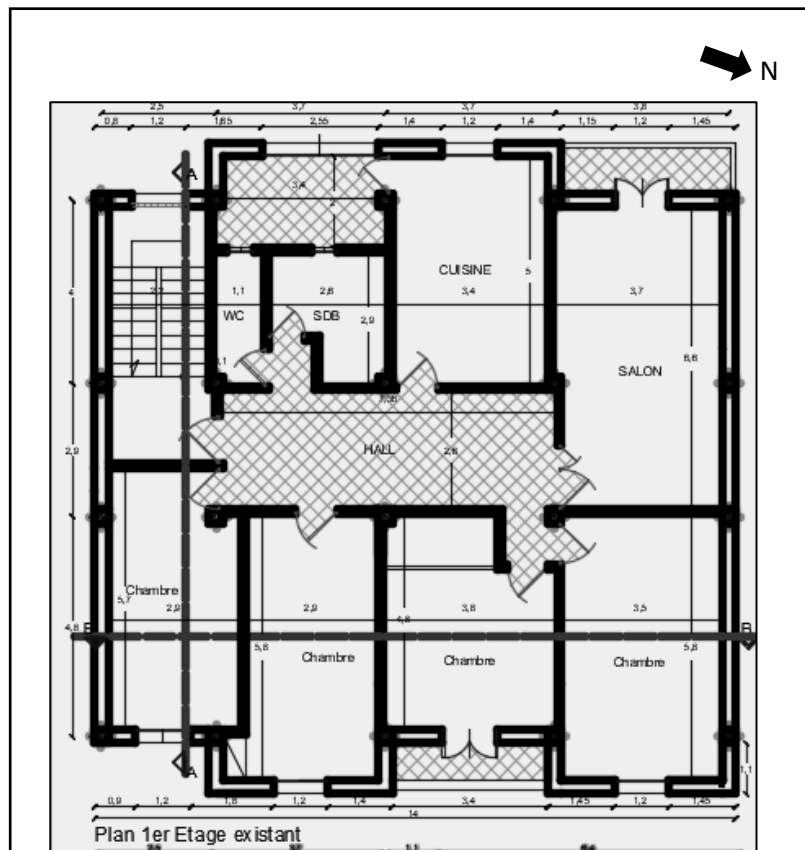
plan 1er étage ech 03 (source: propriétaire)
